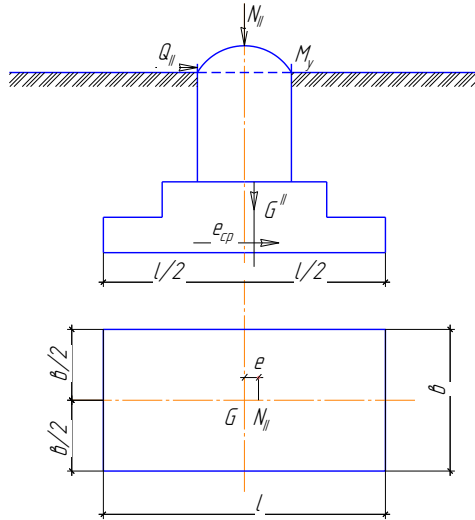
Позацентрово-навантажений фундамент з великим ексцентриситетом.
